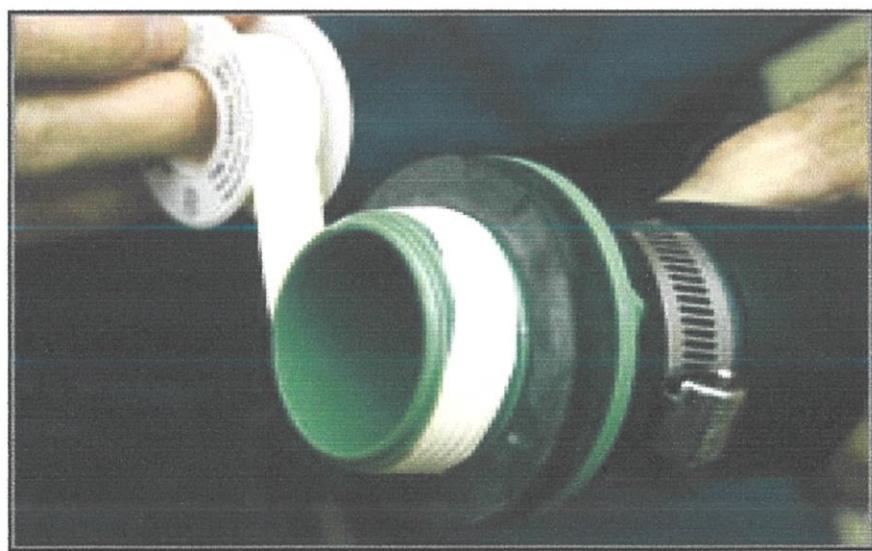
Pemasangan Injap Bebola
